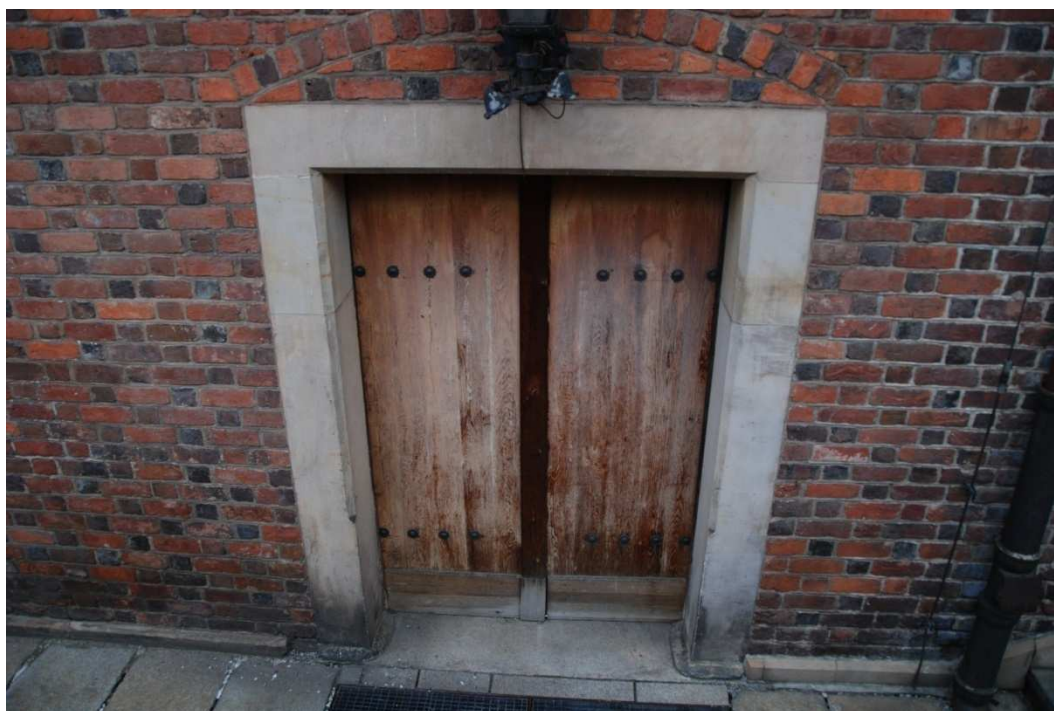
Widok elewacji wschodniej oraz muru w obrębie "fosy".
